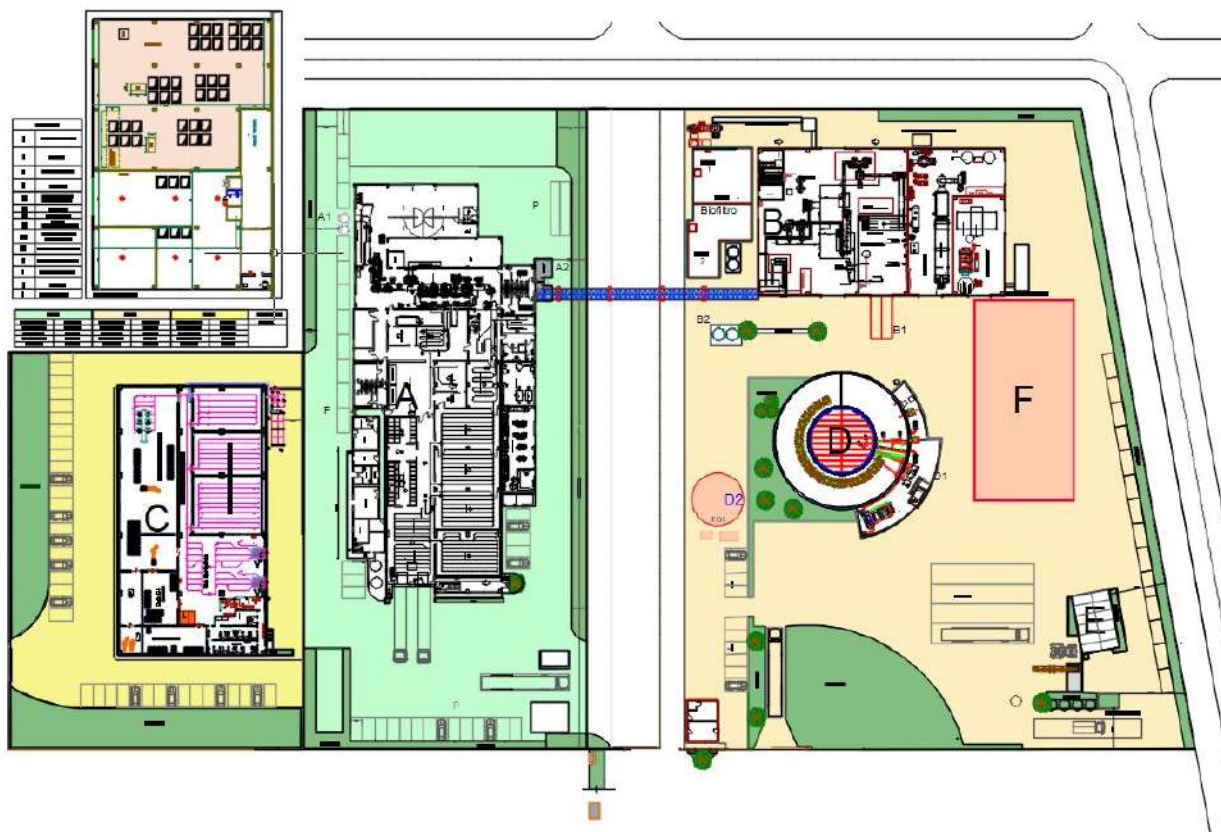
layout dello stabilimento come da planimetria dello stato attuale
